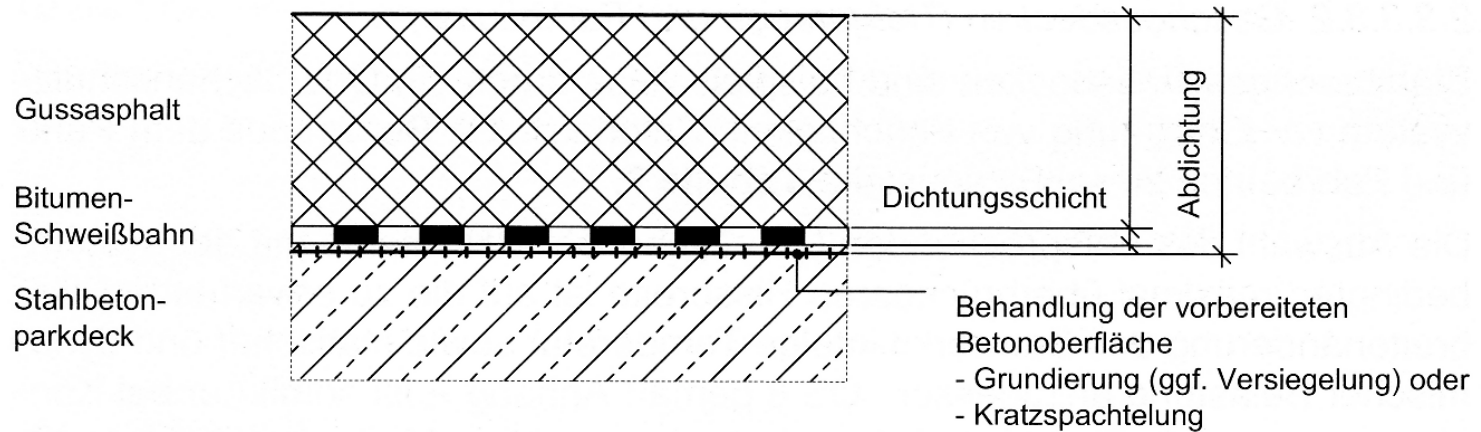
Aufbau einer Abdichtung mit bitumenhaltigen Werkstoffen, in Anlehnung an [R22]
